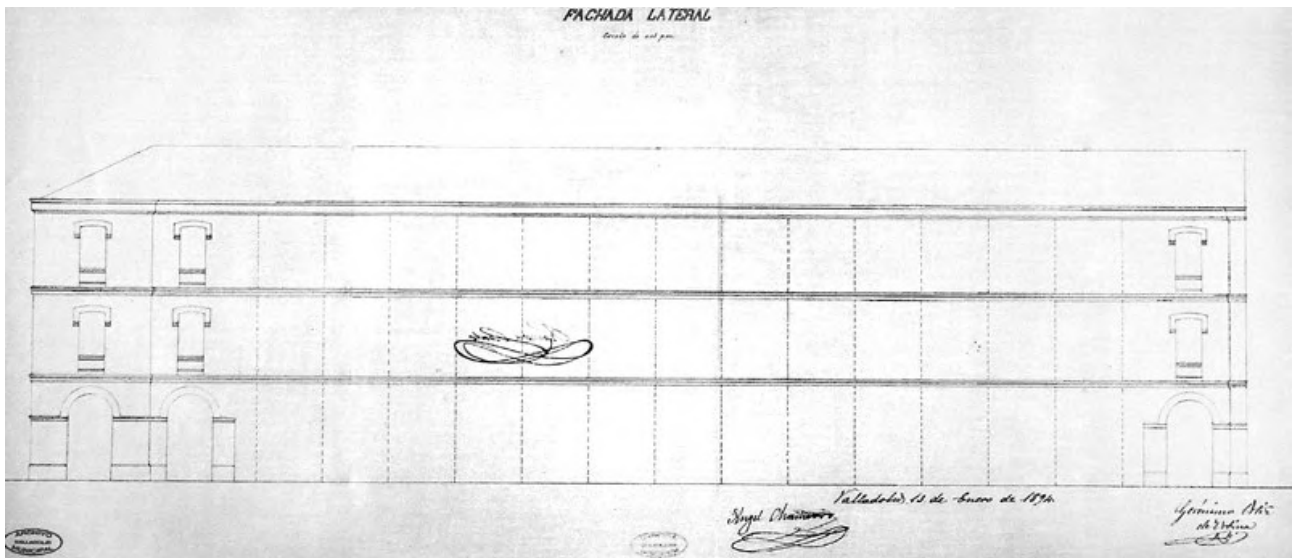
Fachada lateral. Jerónimo Ortiz de Urbina
